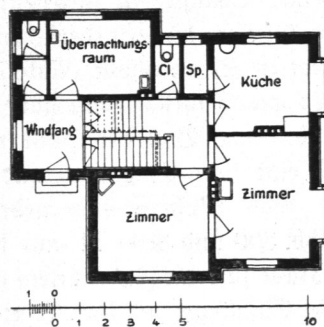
Haltestelle Wandsbecker Chaussee, Wohngebäude, Erdgeschoß.
